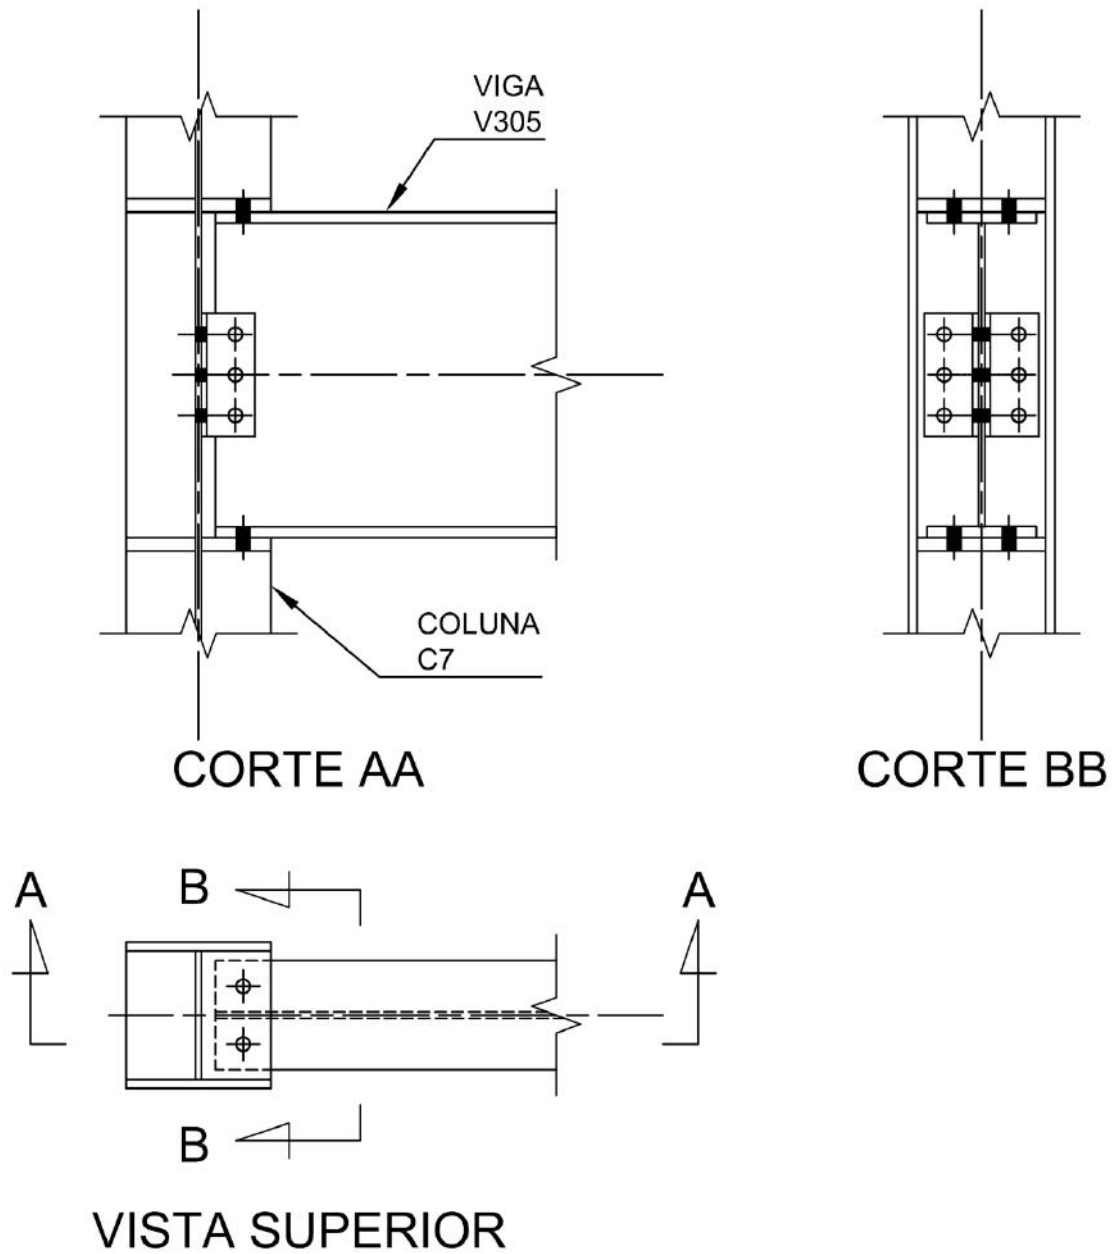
Geometria da ligação viga-coluna (V305 – C7)
